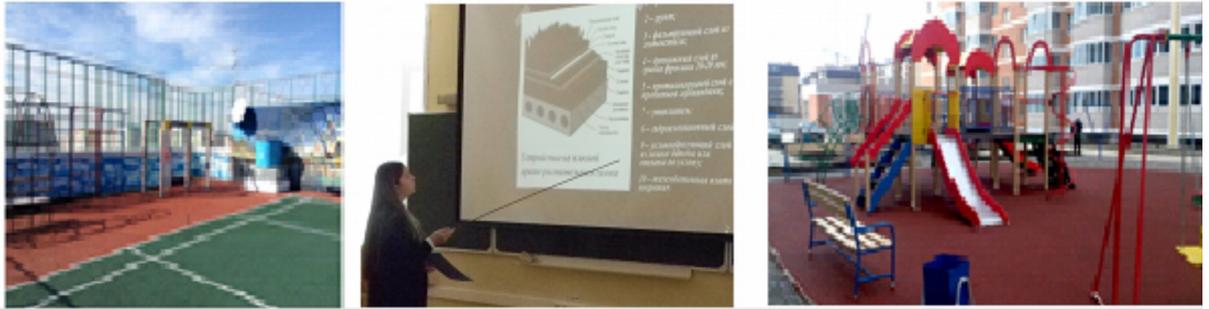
Устройство детской игровой площадки на покрытии 5-этажного жилого дома
